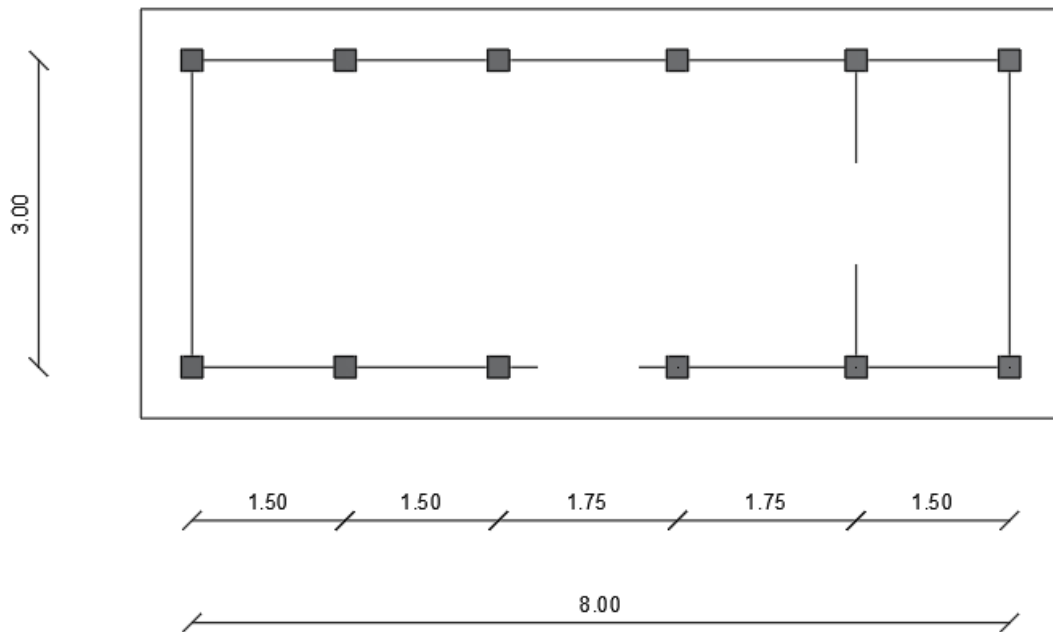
Pianta dell'edificio a seguito delle modifiche.
